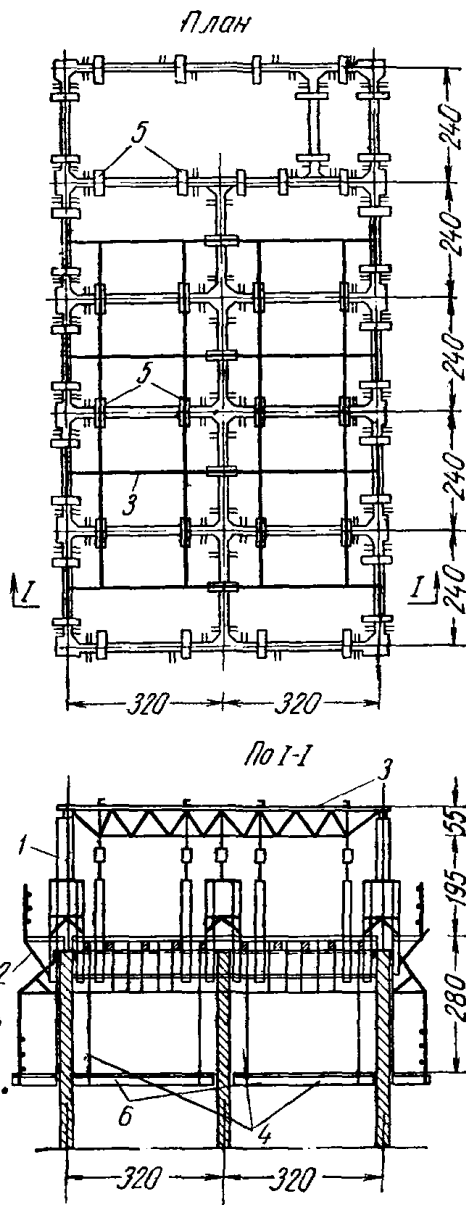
Схема стальной опалубки рабочей башни с опорными фермами
